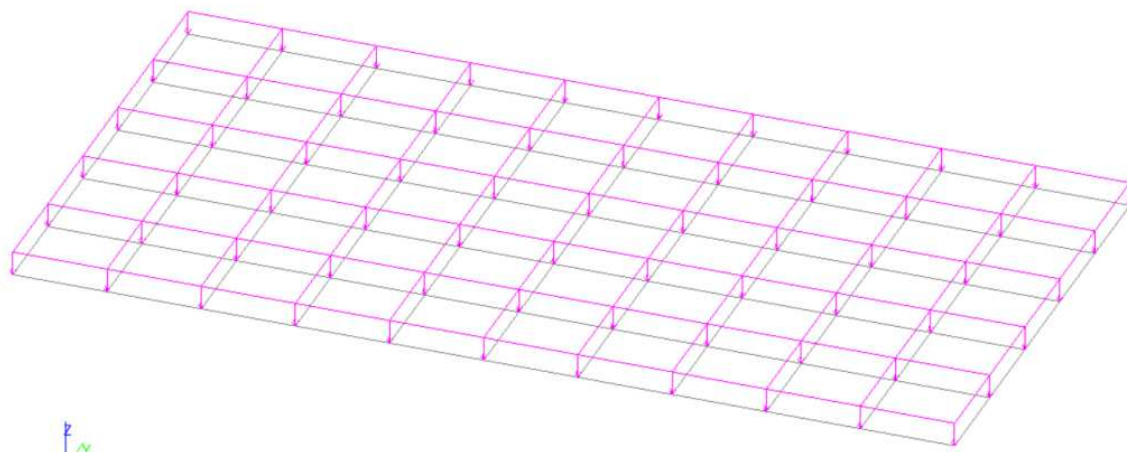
Схема приложения нагрузки на МУ1
